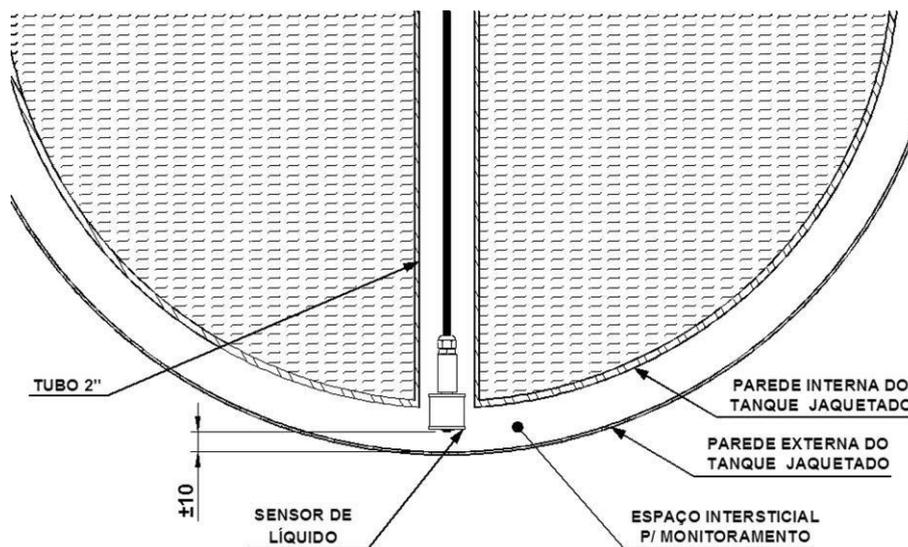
Posicionamento do sensor SmartLiq no tanque de combustível
